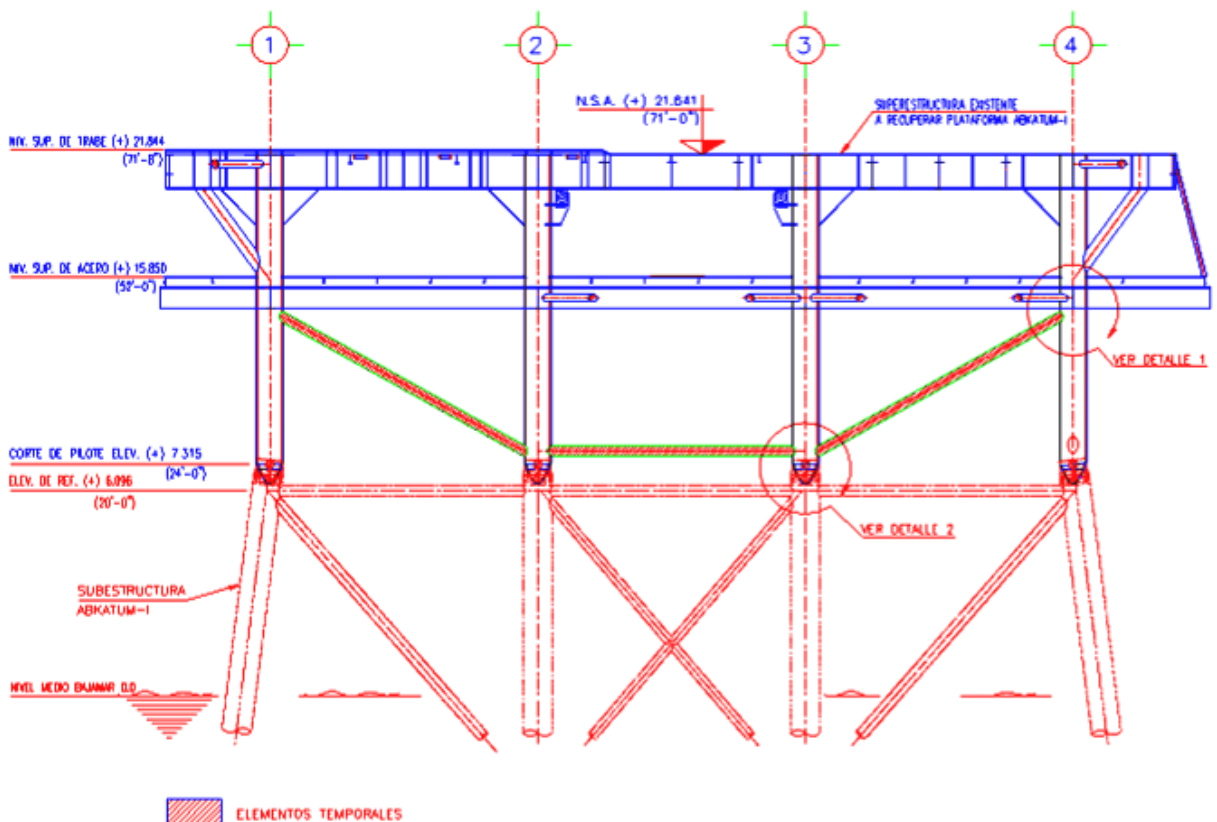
COLOCACIÓN DE ELEMENTOS DE REFUERZO PARA EL IZAJE
